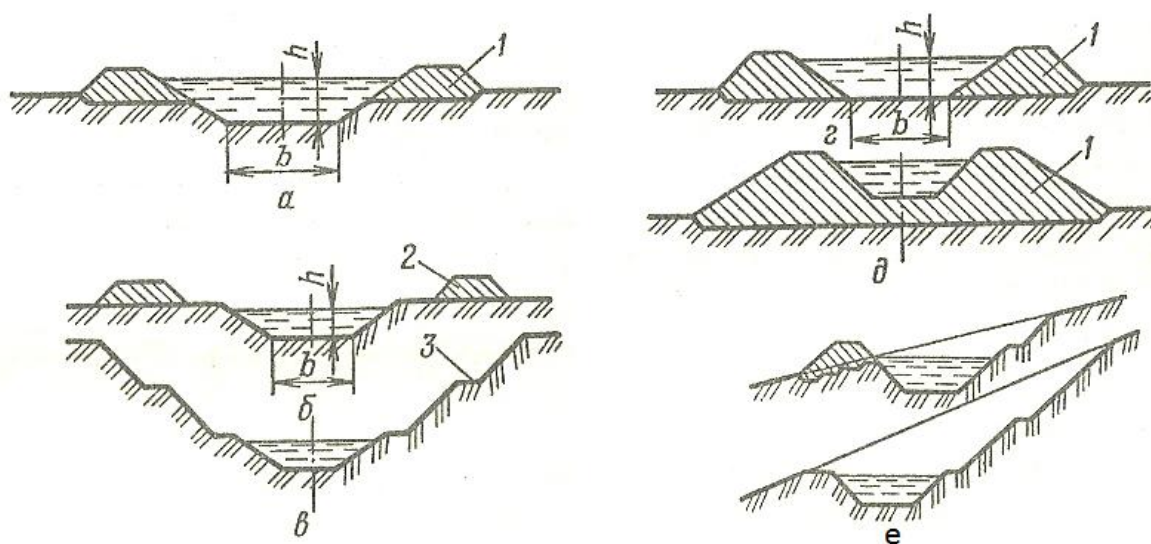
Конструкции каналов: а – в полувыемке-полунасыпи; б, в – в выемке; г, д – в насыпи; е – на крутом склоне; 1 – насыпь с послойным уплотнением; 2 – кавальер; 3 – берма; h – глубина воды; b – ширина по дну.
